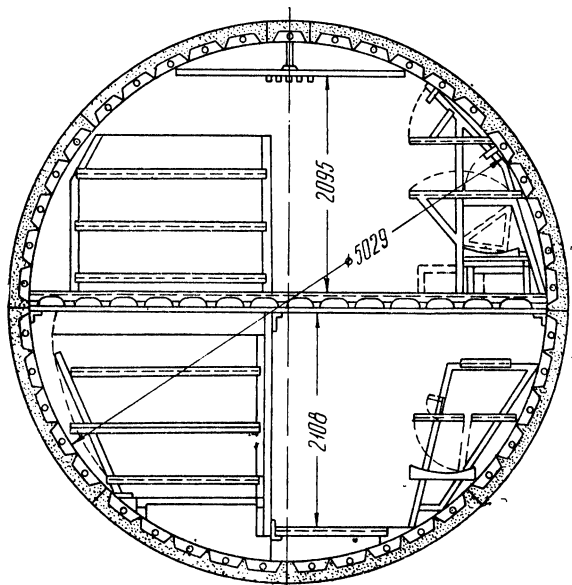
Поперечное сечение убежища для населения с обделкой из железобетонных тюбингов (Лондон)
